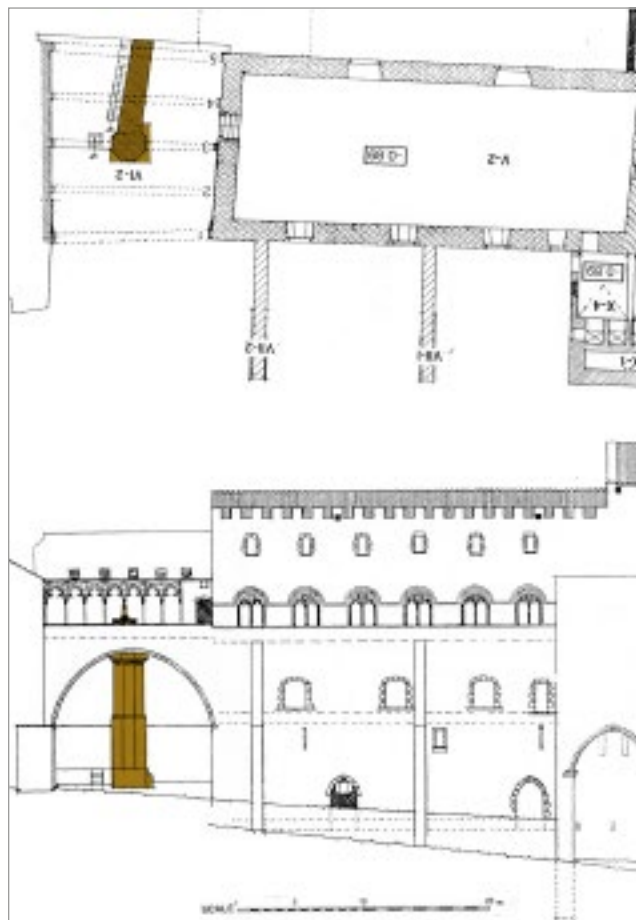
Planimetria e prospetto settentrionale del Palazzo Papale. In evidenza la Fons papalis (riel. da RADKE 1996).
